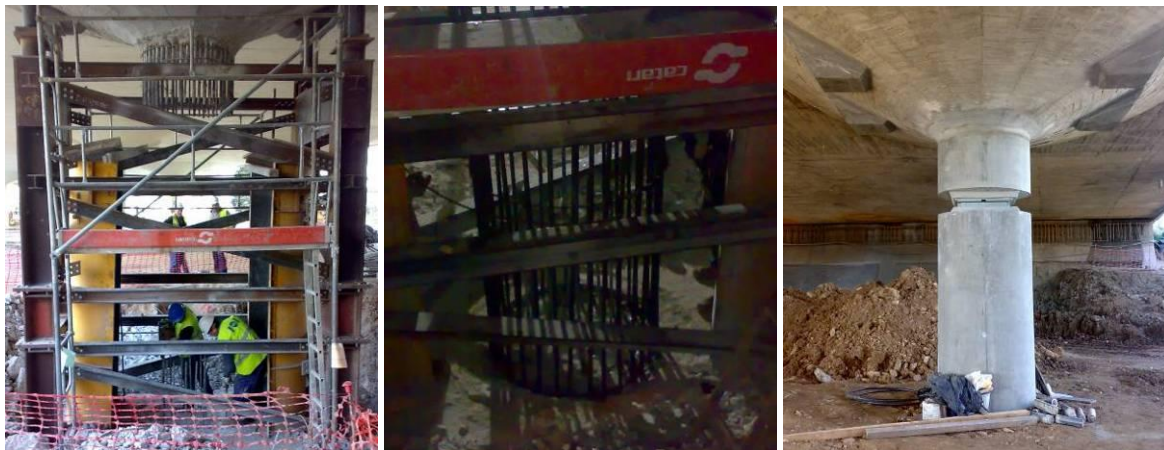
Pormenor da suspensão do tabuleiro após a demolição do pilar existente, pormenor da selagem de varões para o “novo pilar; pilar após intervenção.
